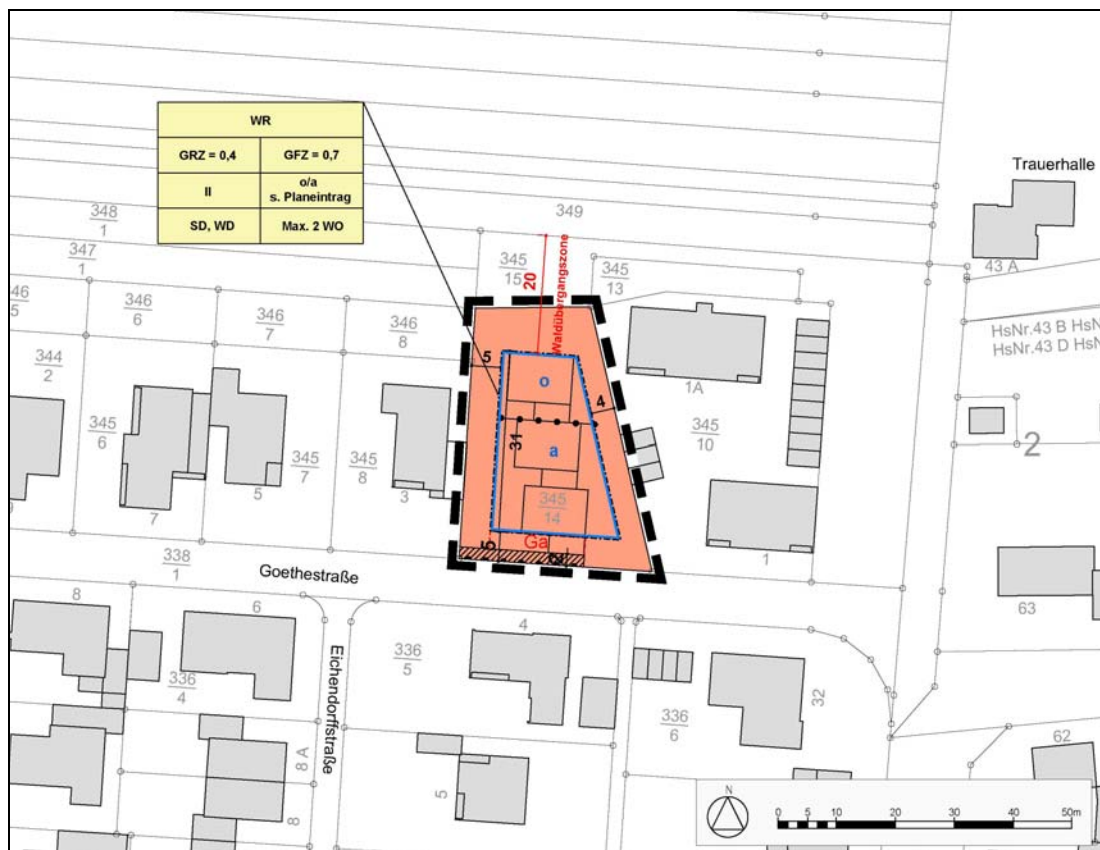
Änderung 1 zum Bebauungsplan „Friedhofstr. Hermann- Löns- Straße- Teiländerung Goethestraße Nord“ - Planzeichnung, Quelle: eigene Darstellung
